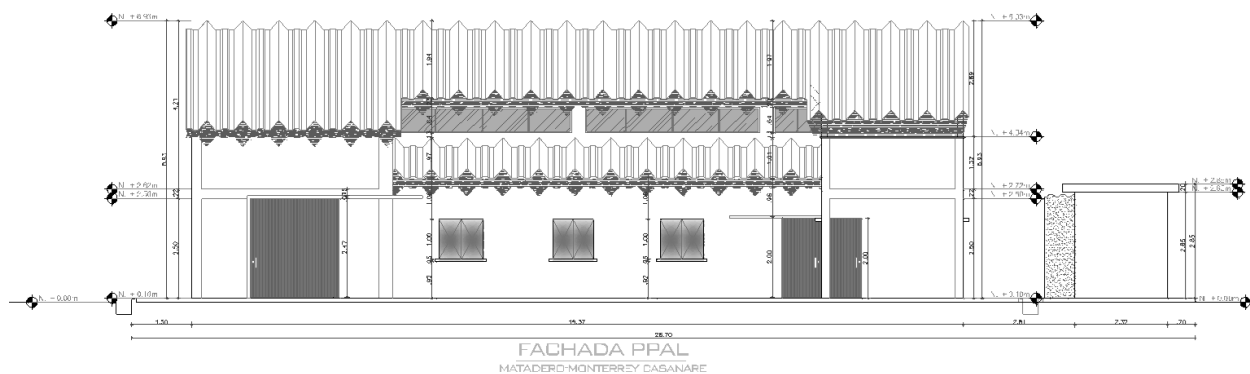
Fachada principal. Fuente: Elaborado por el autor.
